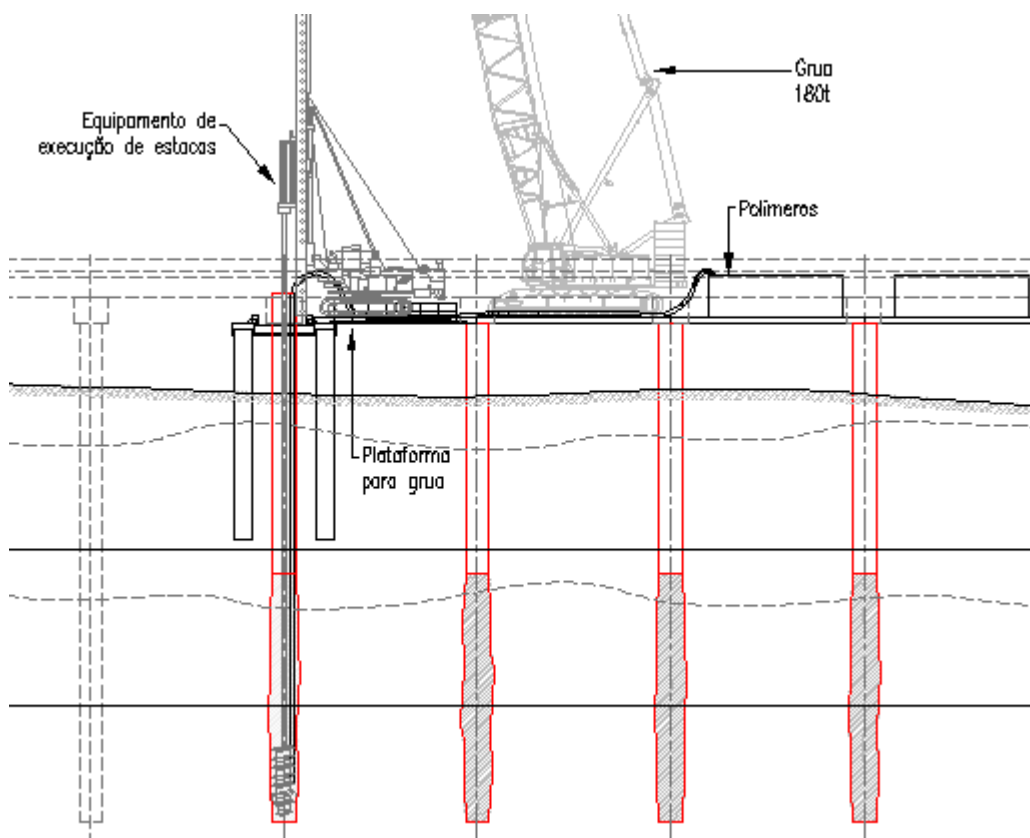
Fase 3 – Furação de solos, em profundidade.
